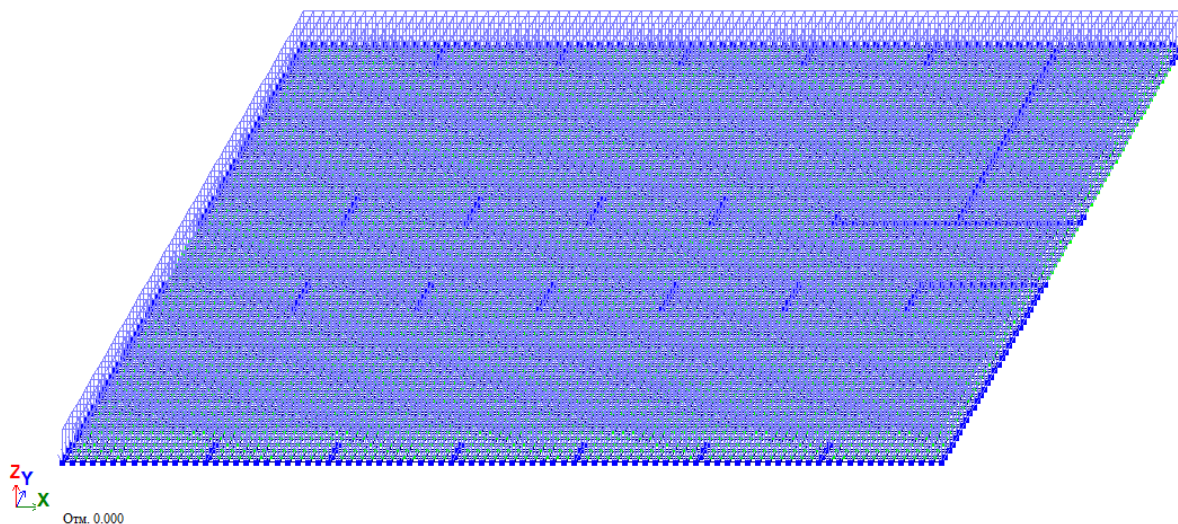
Расчетная модель участка плиты перекрытия
